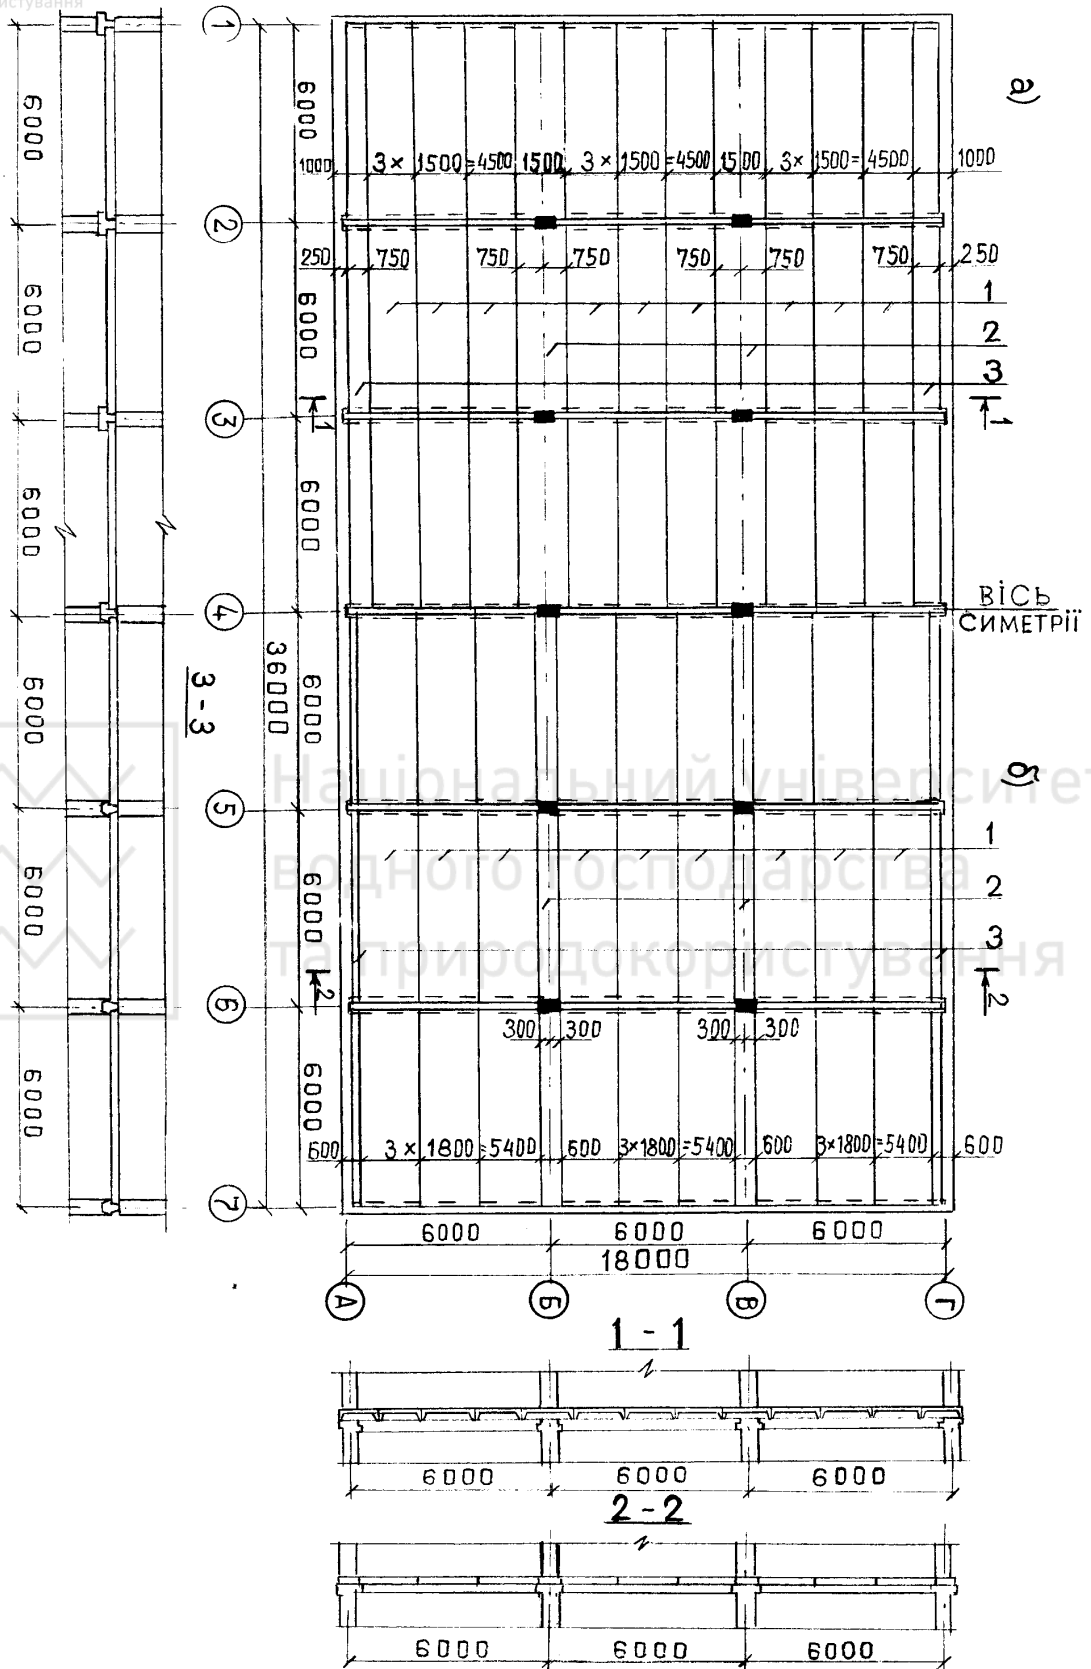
Конструктивна схема збірного перекриття: а – з ребристими плитами ; б – з багатопустотними плитами; 1 – рядові плити; 2 – зв’язуючі плити – розпірки; 3 – фасадні плити – розпірки
